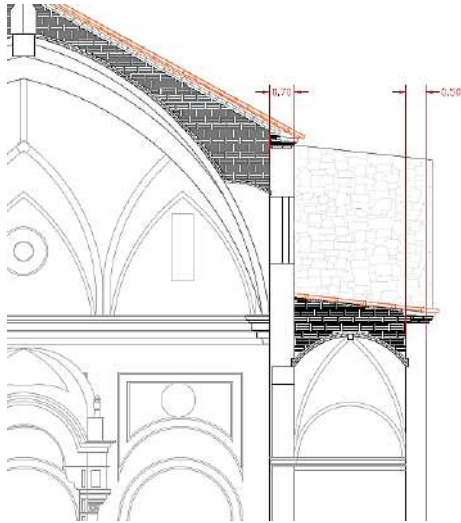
Detalle de los muros en sección transversal. Imagen propia 20/08/17
